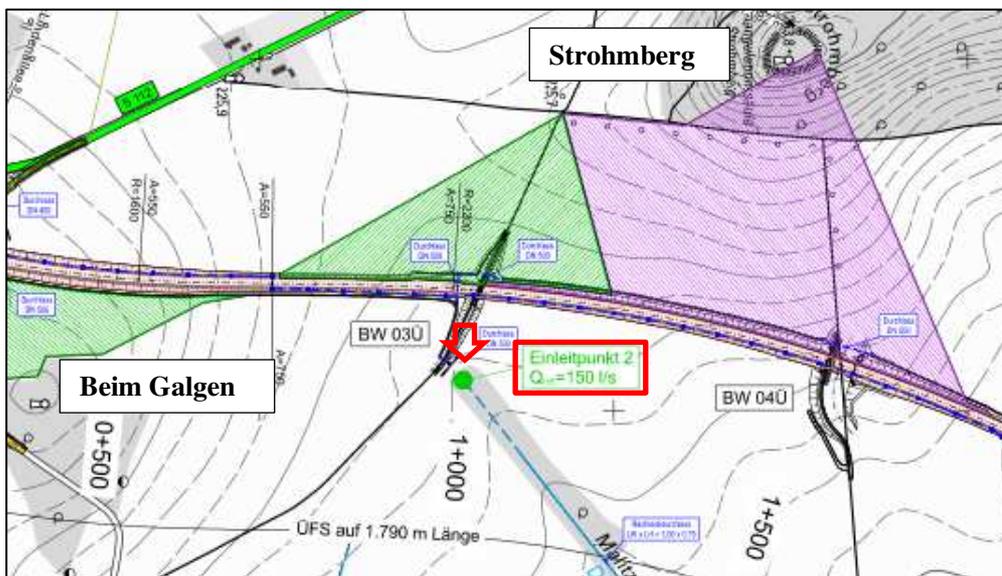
Entwässerungsabschnitt 2 - Ausschnitt aus dem Übersichtslageplan zum Wassertechnischen Bericht (Unterlage 8) mit dem ersten Einleitetpunkt (Einleitetpunkt 2) in den Dohegraben
